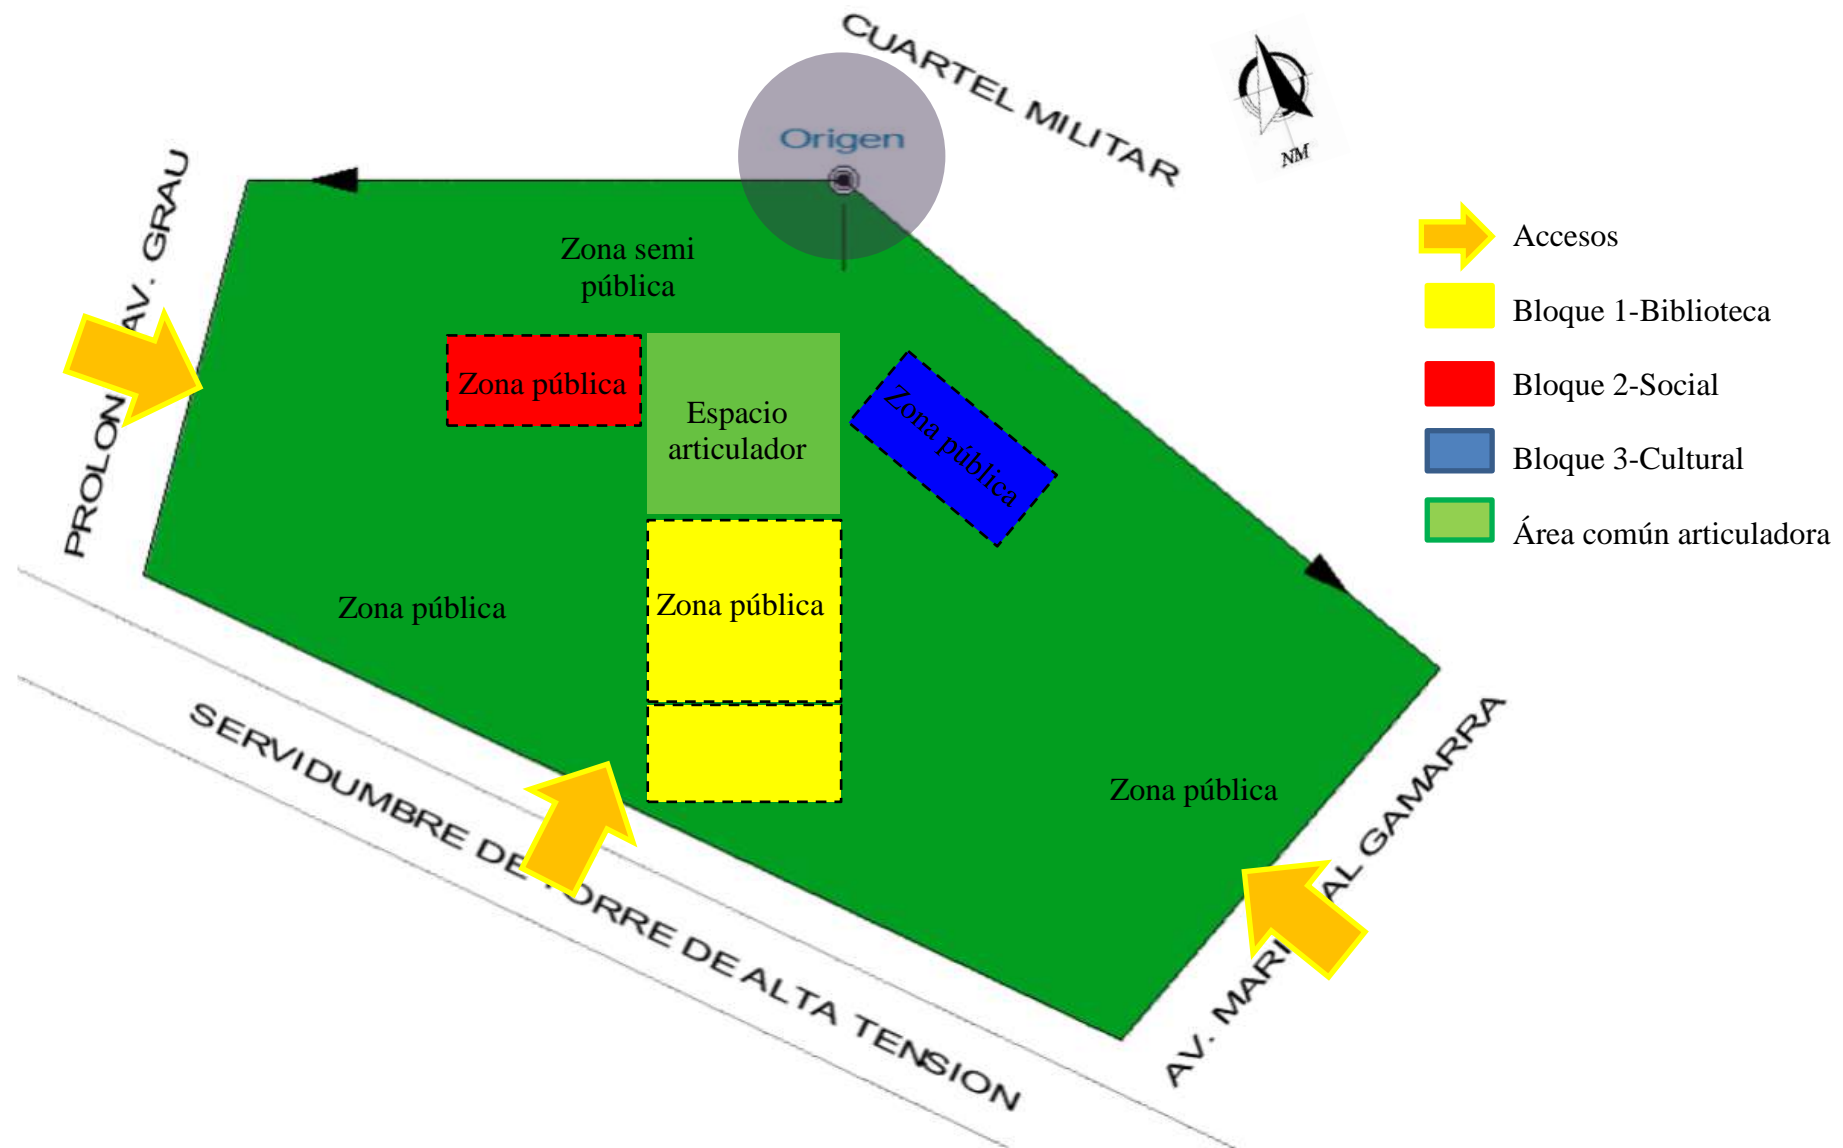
Planteamiento Espacial por Zonas según el Escenario.
